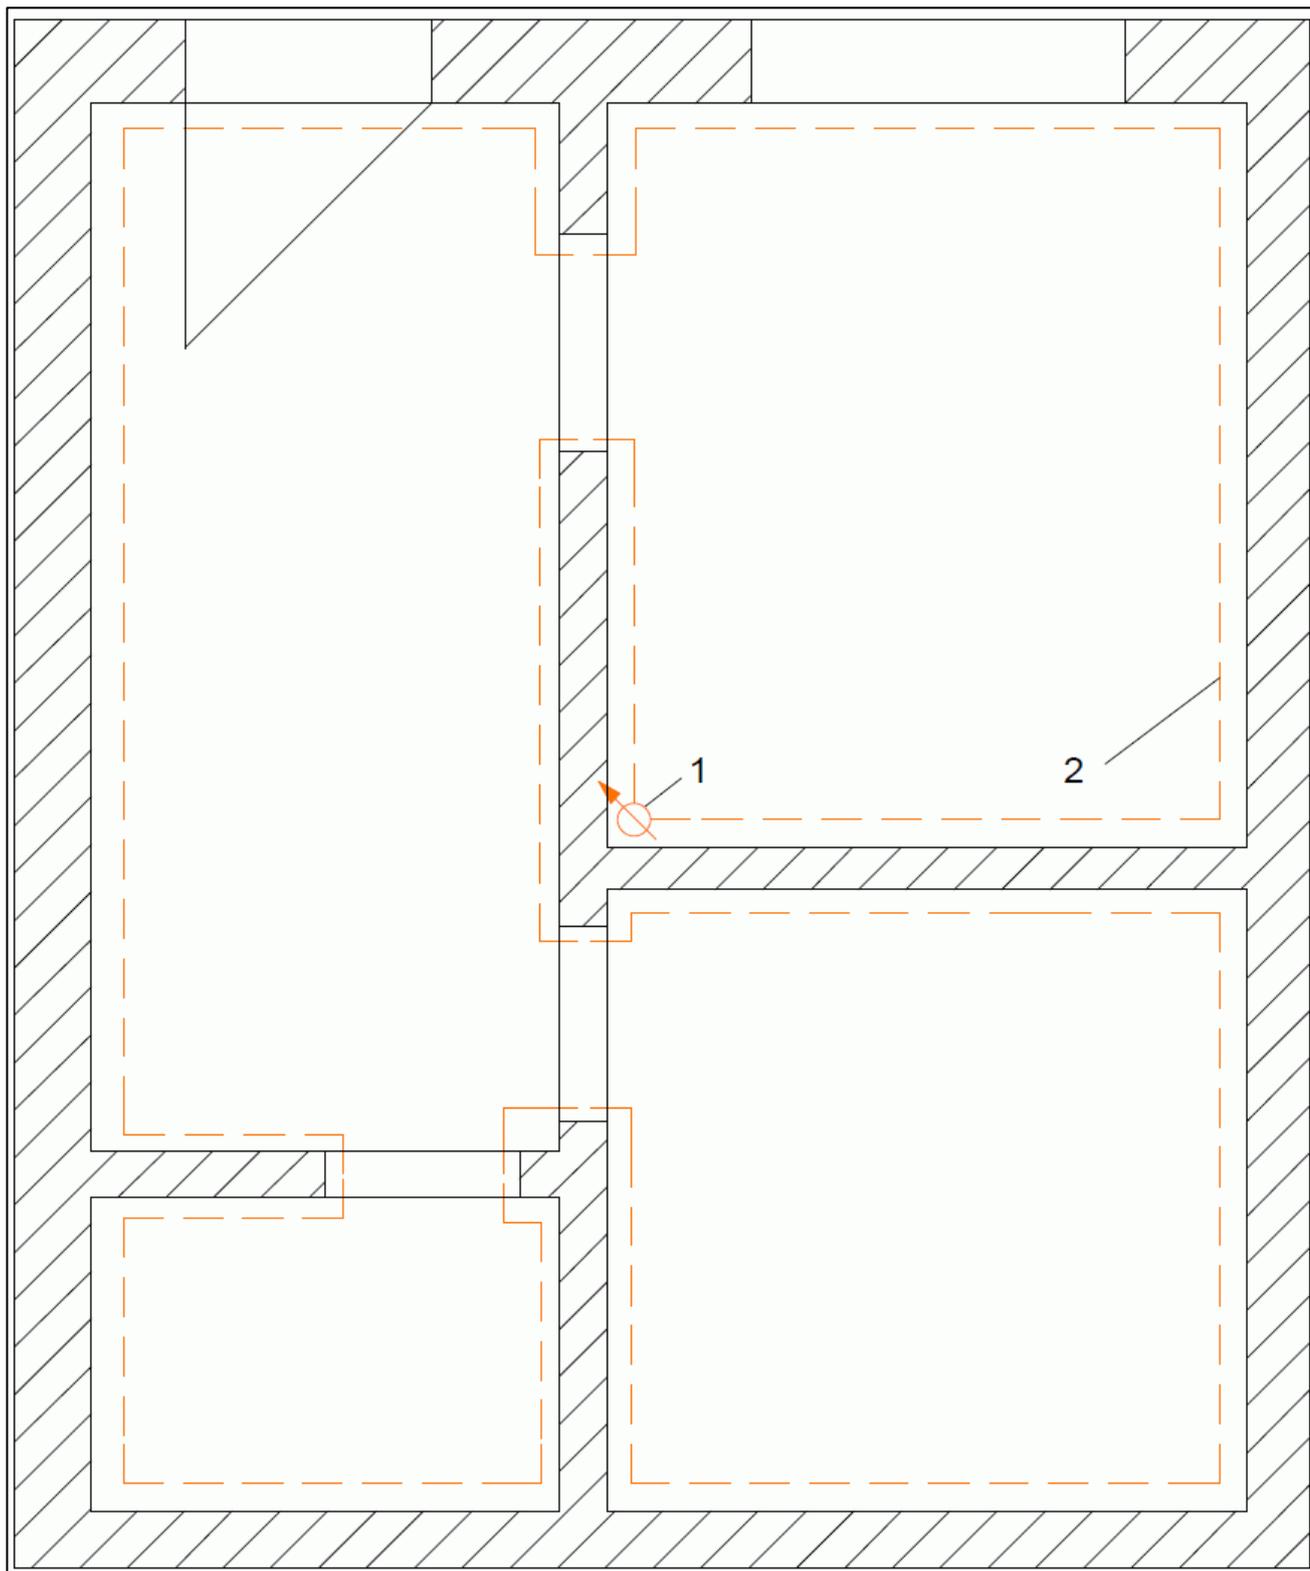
Grundriss, Anordnung Radondrainage am Wandanschluss
